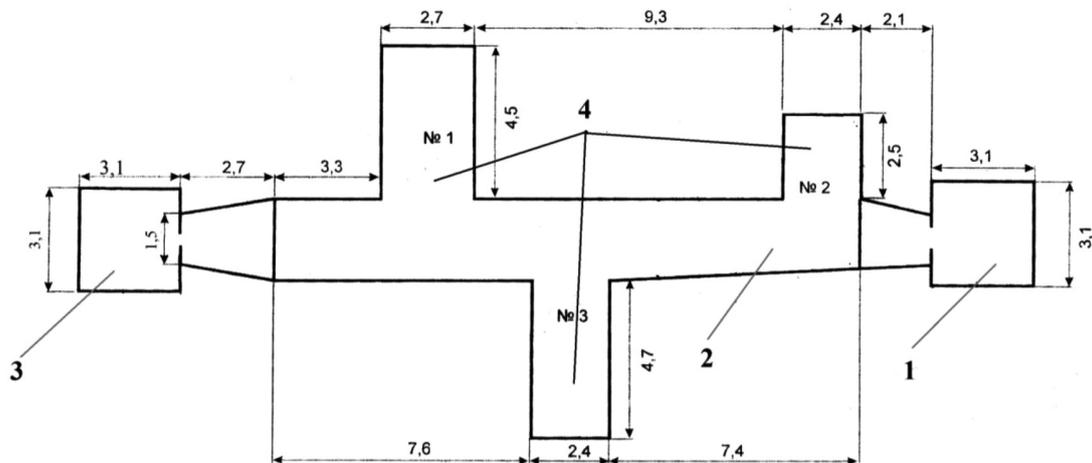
Рабочие помещения криохранилища: 1 – вертикальный ствол, 2 – основное рабочее помещение, 3 – вертикальный грузовой ствол, 4 – боковые рабочие помещения
